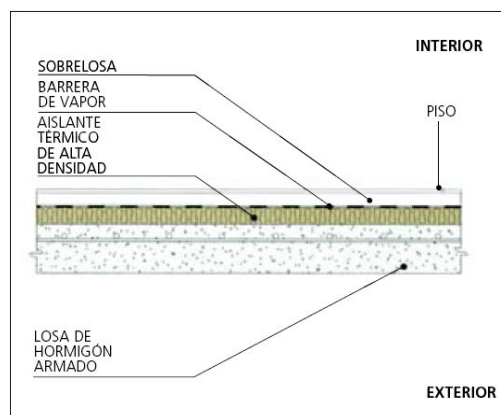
Piso con losa y aislante térmico adosado en cara interior⁽²²⁾.
